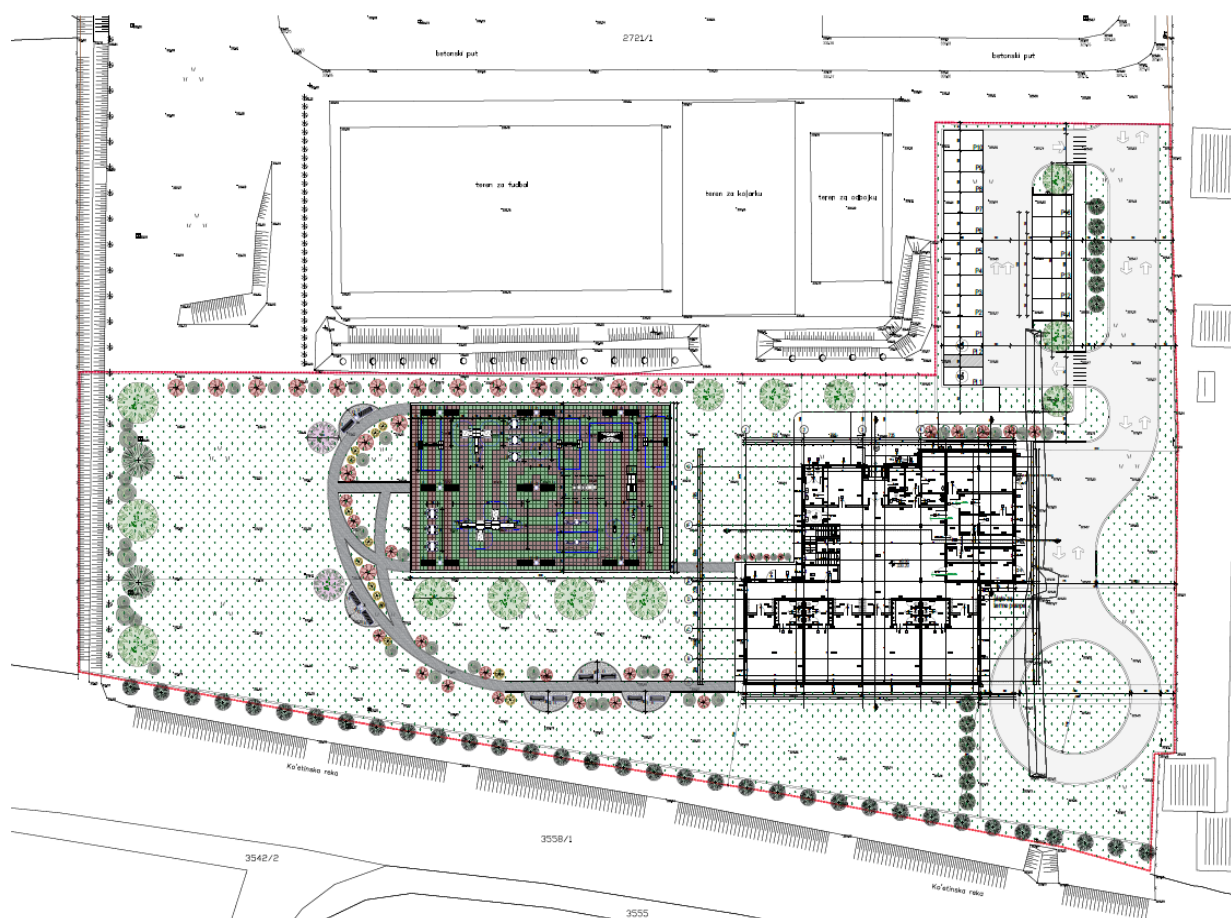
Prikaz lokacije na kojoj je planirana izgradnja objekta
